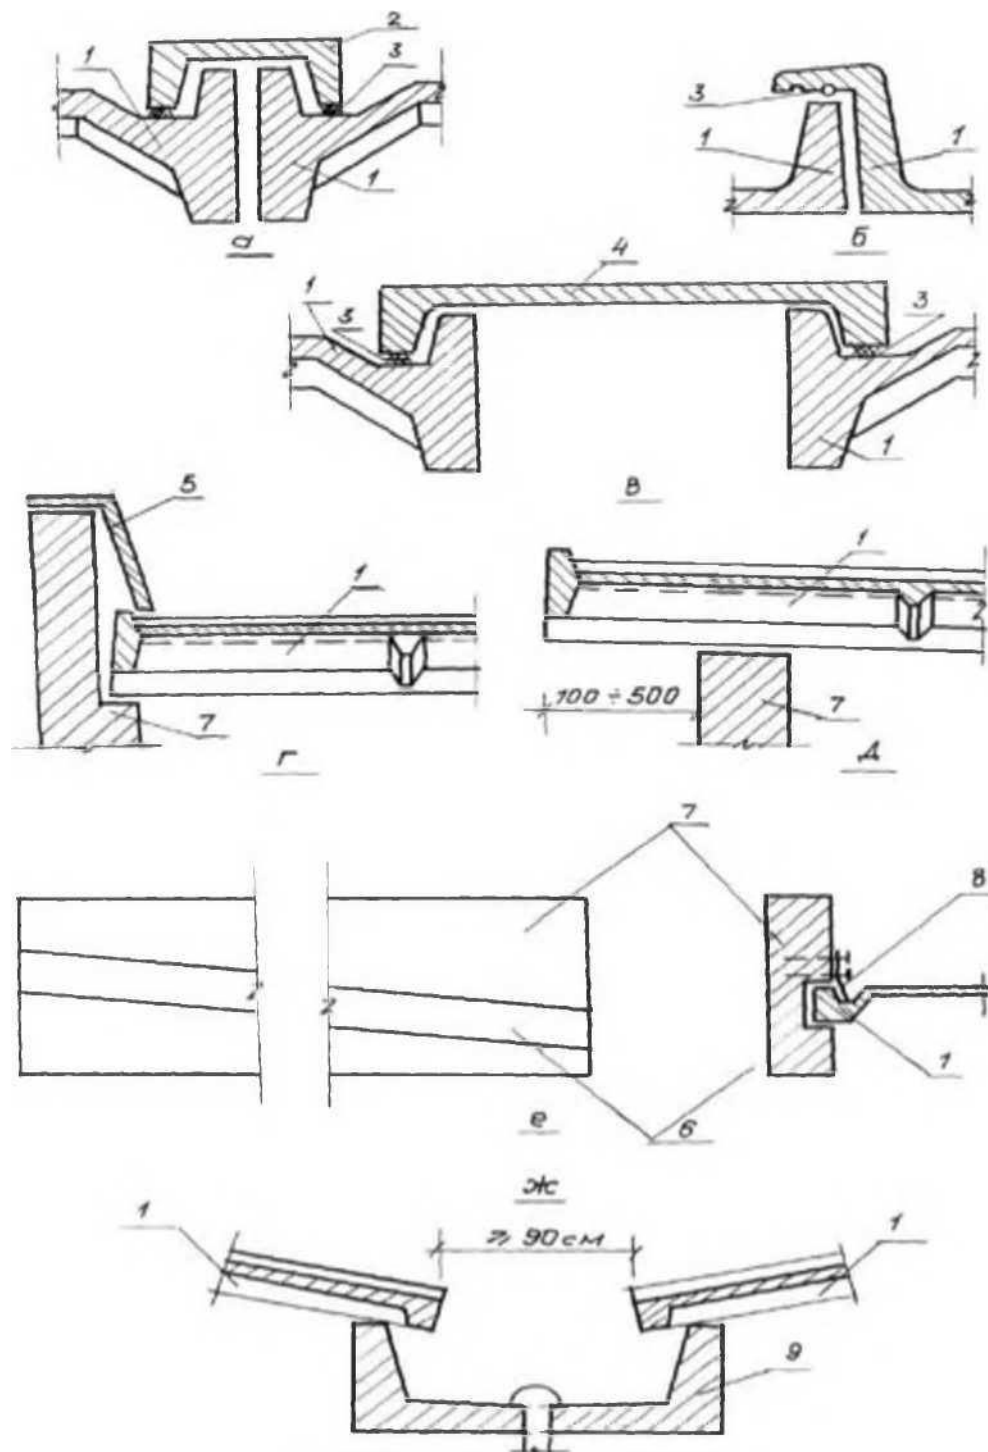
Схемы стыков и примыканий сборных железобетонных кровельных элементов
